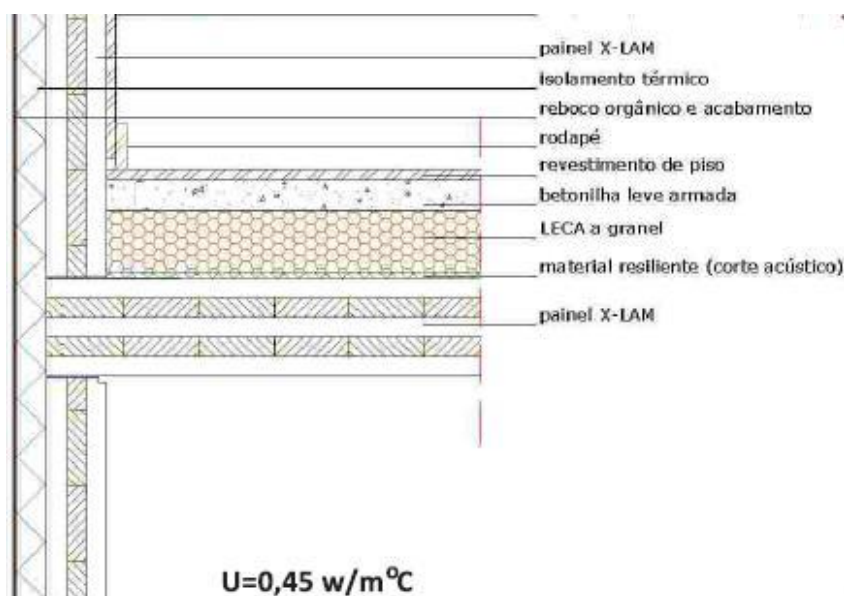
Pormenor da ligação fachada-laje [22]
